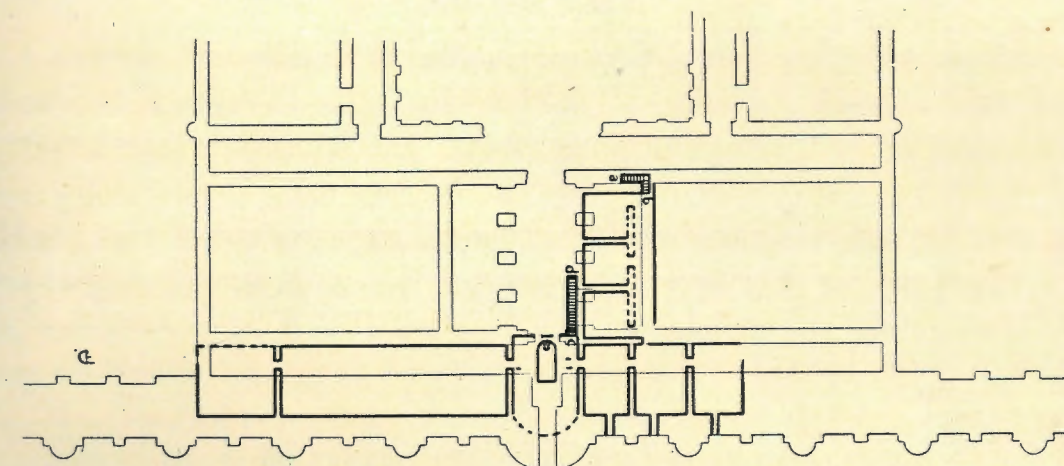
2° Plan du demi-étage (trait fin pour rappeler les lignes du plan du rez-de-chaussée sous-jacent).
